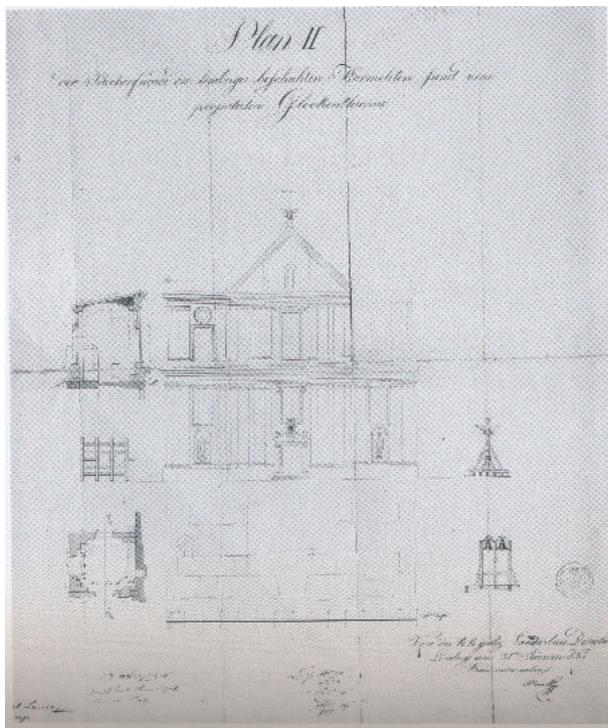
Kirche des Erzengels Michael, Plan der Fassade, Lwiw, 1835.
